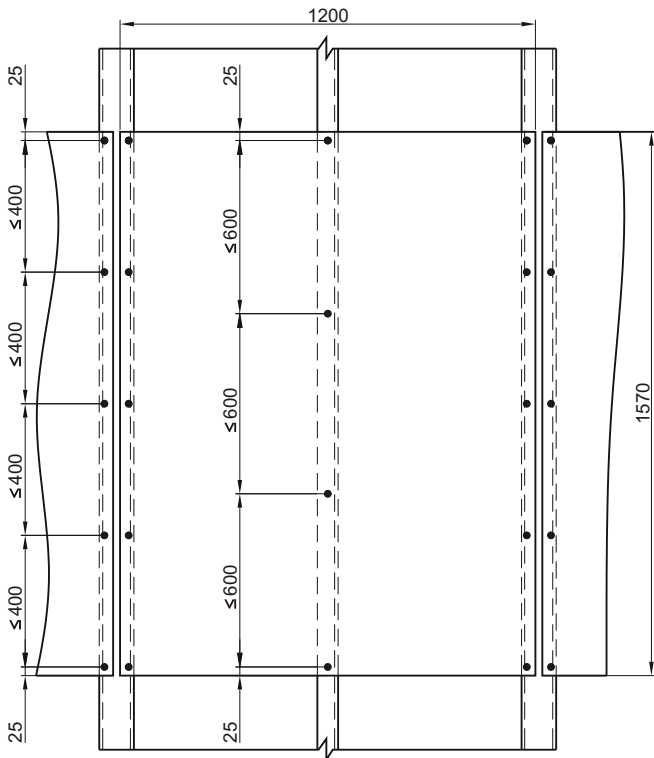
Схема крепления плоских панелей для здания высотой до 12 этажей
